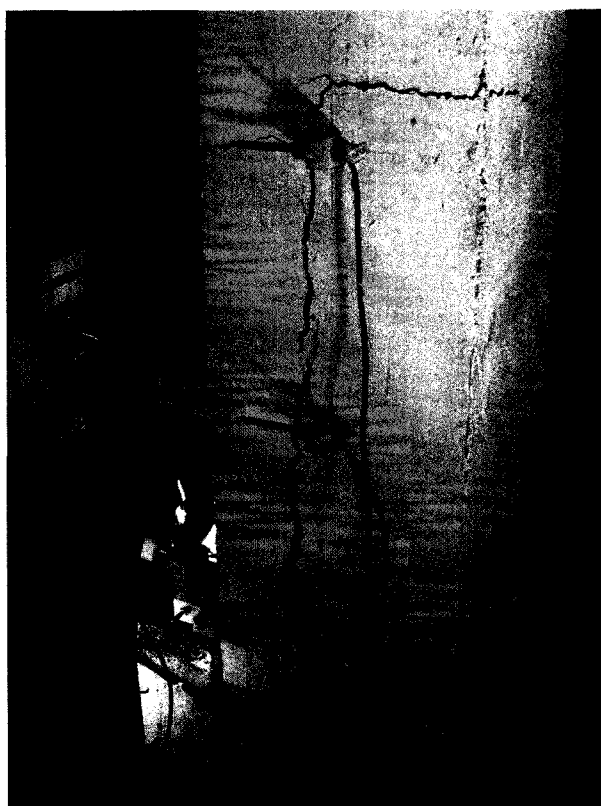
Début de la fissuration à 250 kN
